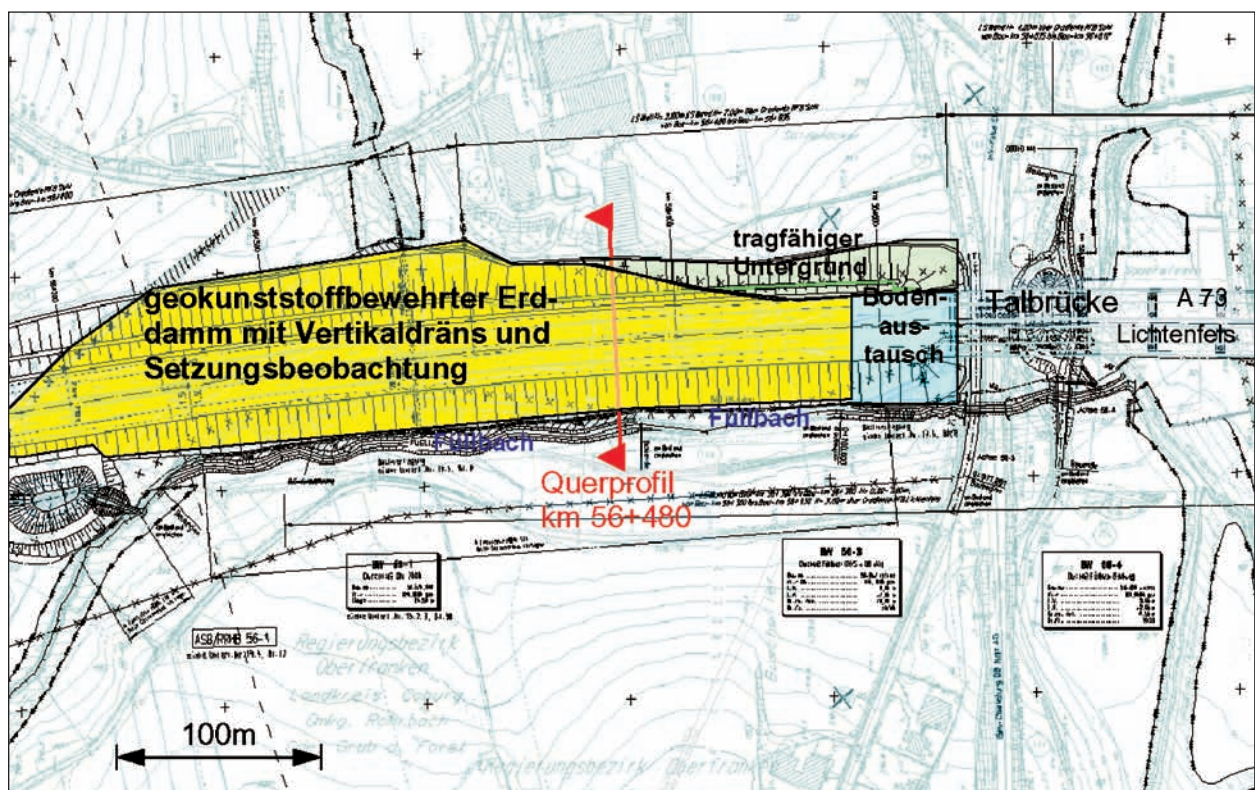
Lageplanausschnitt mit bautechnischen Maßnahmen
